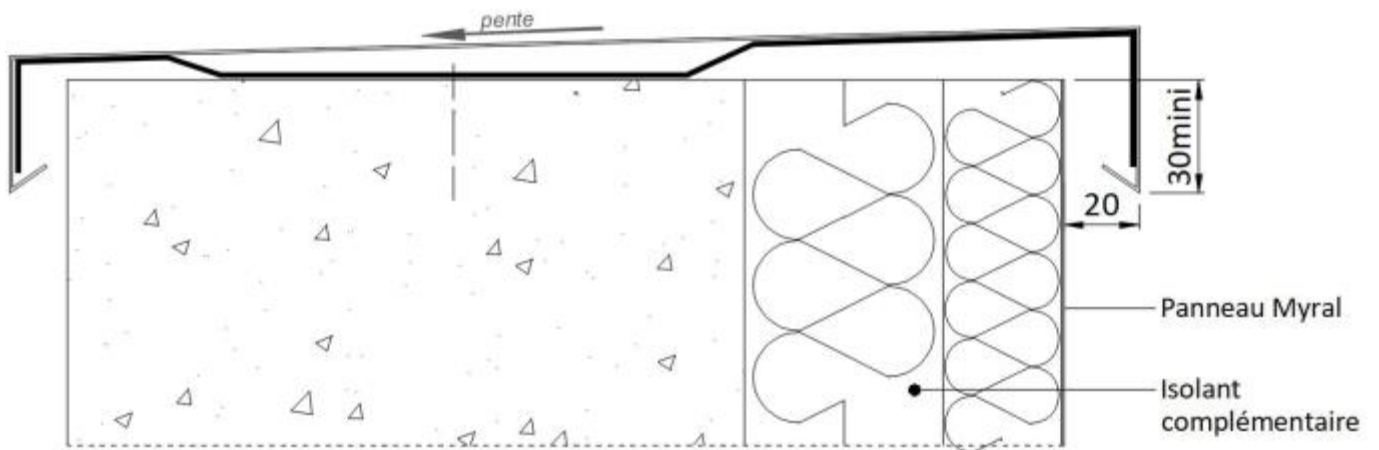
Bas de façade - Pose en vêtage (coupe verticale)
